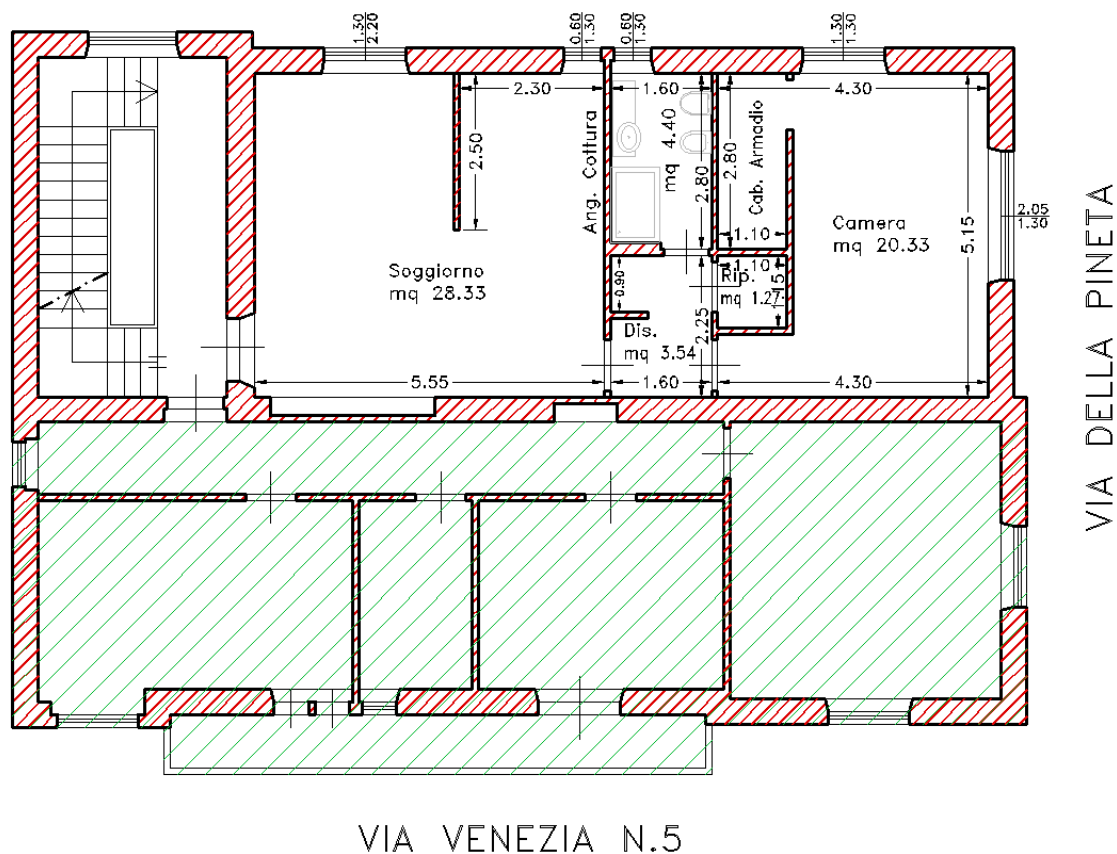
Planimetria piano secondo allegata all'ultima pratica edilizia depositata presso il SUAPE di Cagliari – Allegato 3
